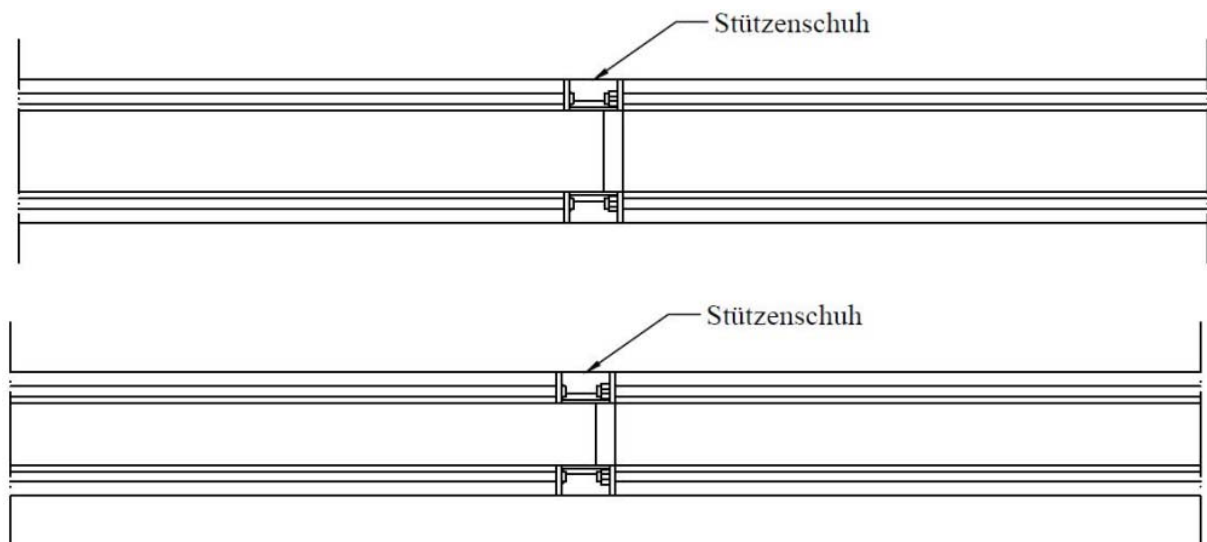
Prinzipsskizze des nachträglichen Stoßes der Bewehrung mittels Stahleinbauteil und Verschraubung
